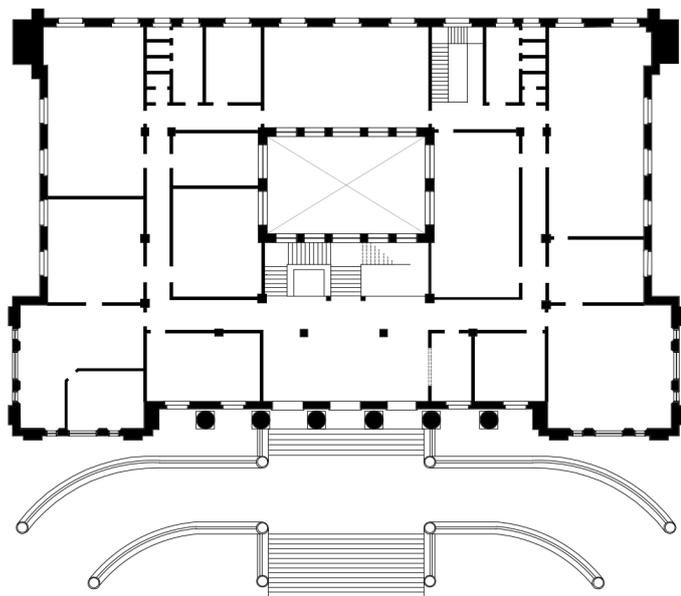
Redesenho planta do 1º andar, Secretaria de Obras Públicas, 1944.
